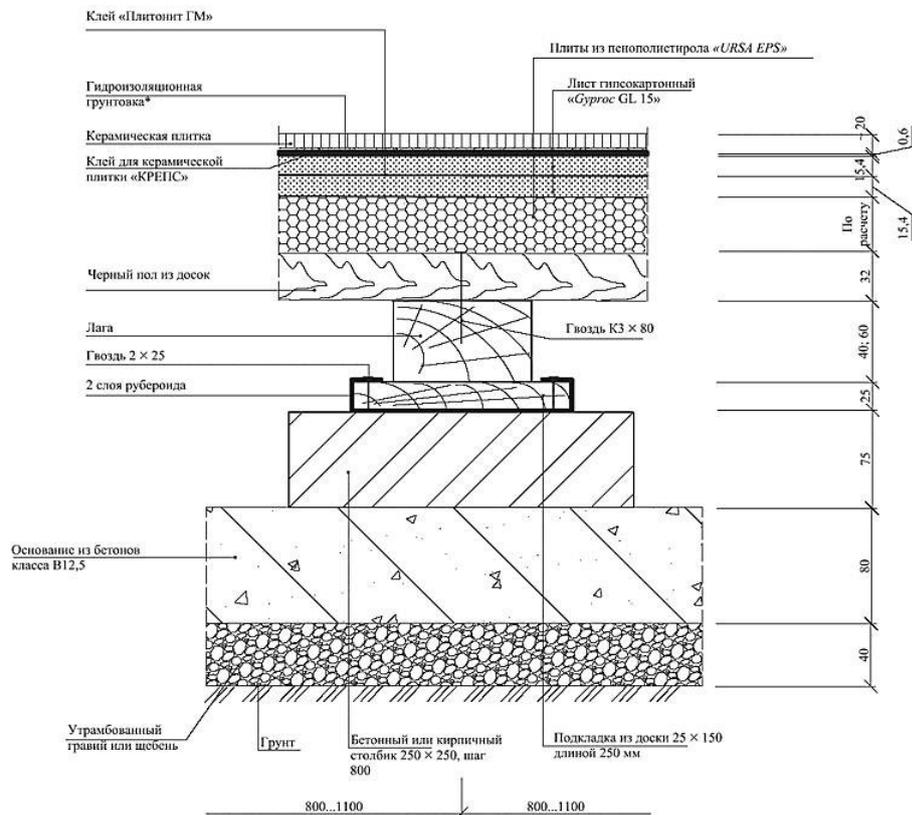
Конструкция пола первого этажа по грунту из керамической плитки.
